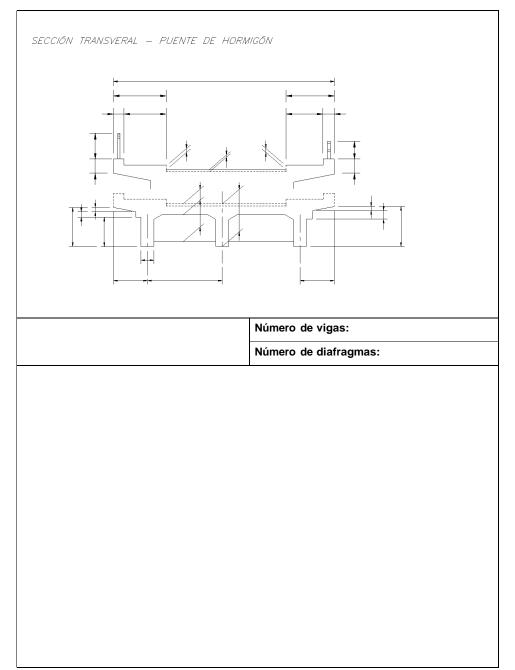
Hoja de Medición (Sección Transversal para Puente de Concreto)
